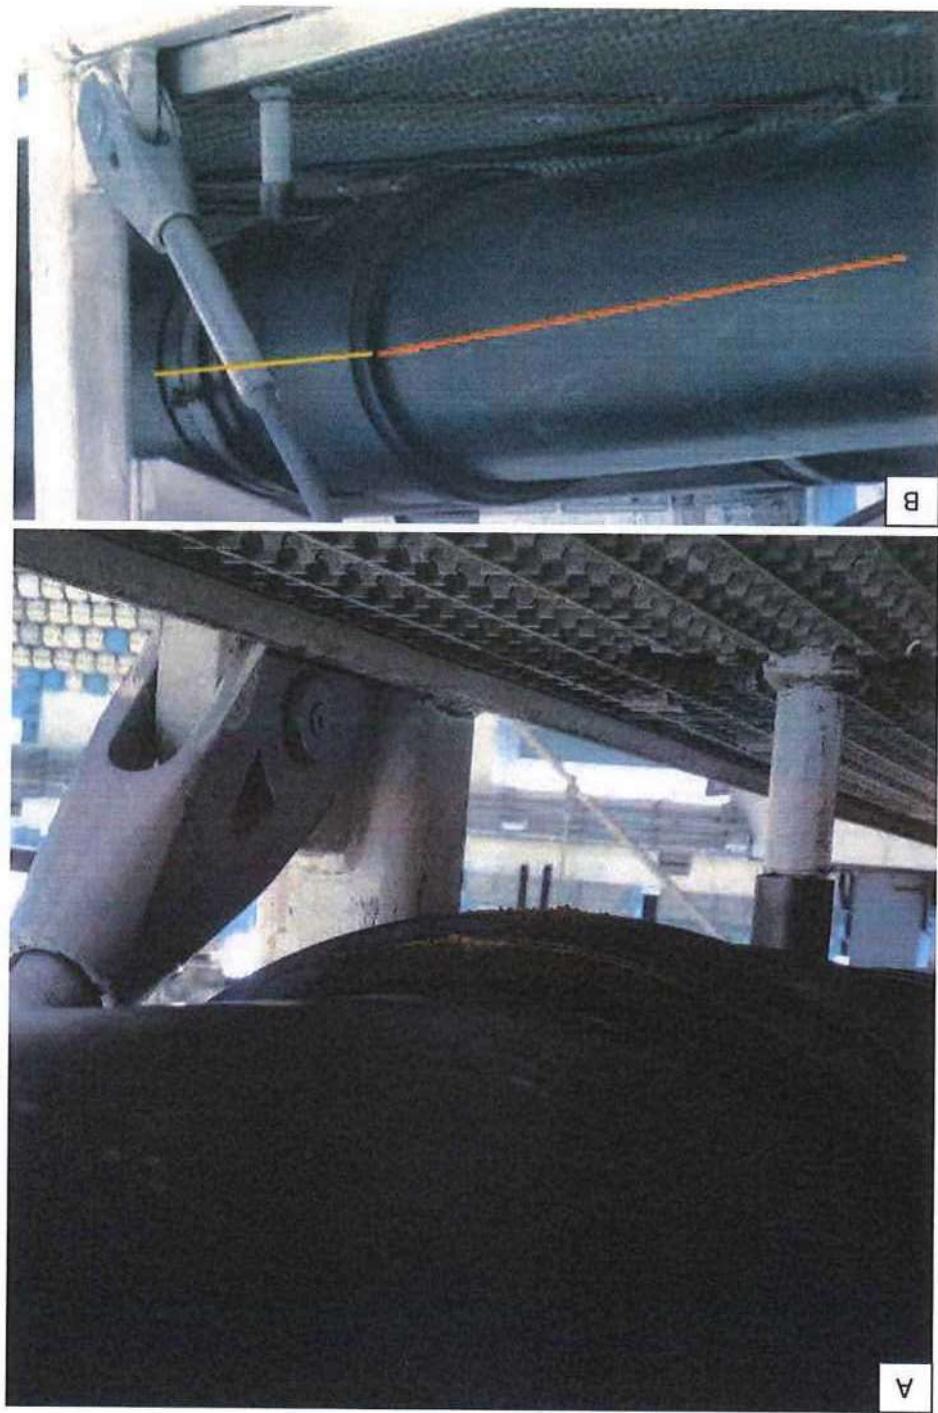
Montagem indevida do suporte da tubulação de drenagem no eixo 7,5
